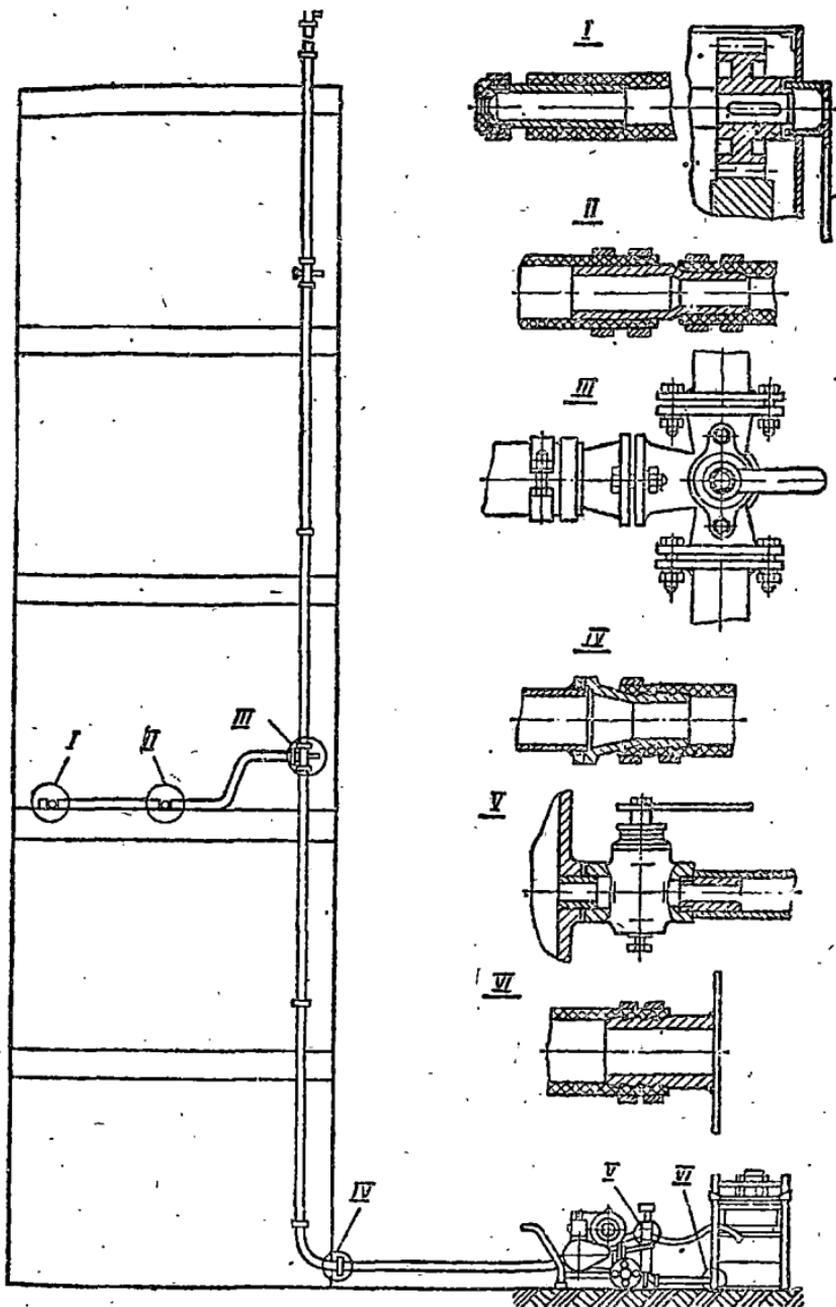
Схема сборного металлического растворопровода к установкам СО-48, СО-49 и СО-50:
